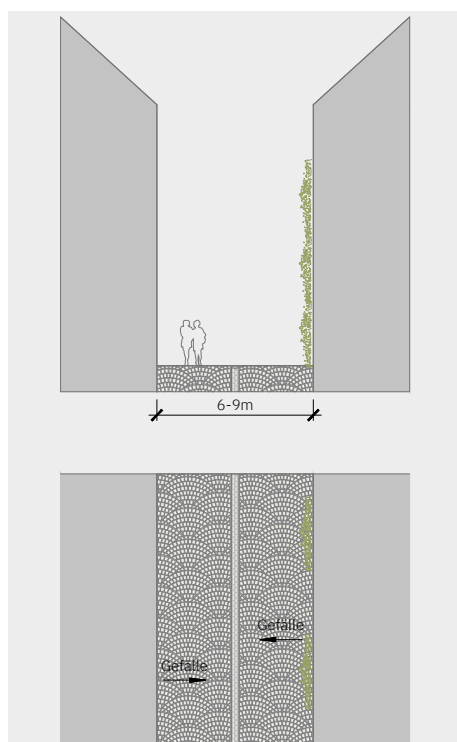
Bogenpflasterung, flächige Fassadenbegrünung (Uniola 2025)
